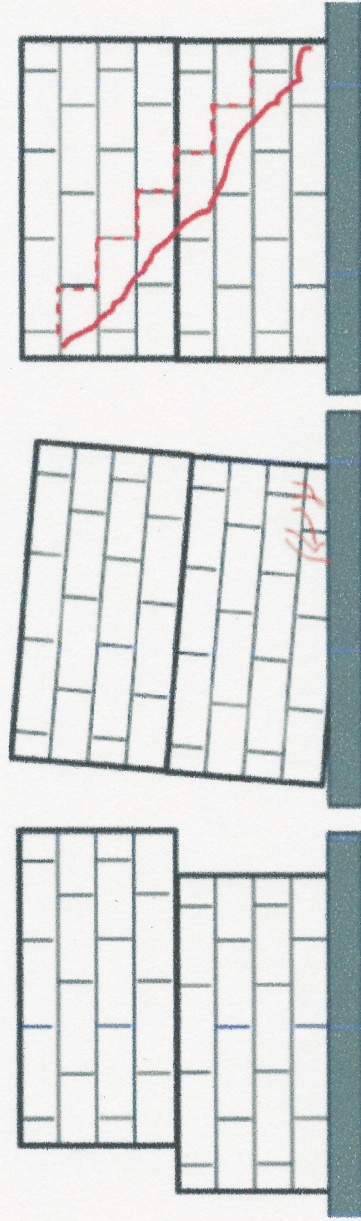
Modos de fallas de la mampostería. Deslizamiento, falla a compresión en zona inferior y grietas diagonales.
